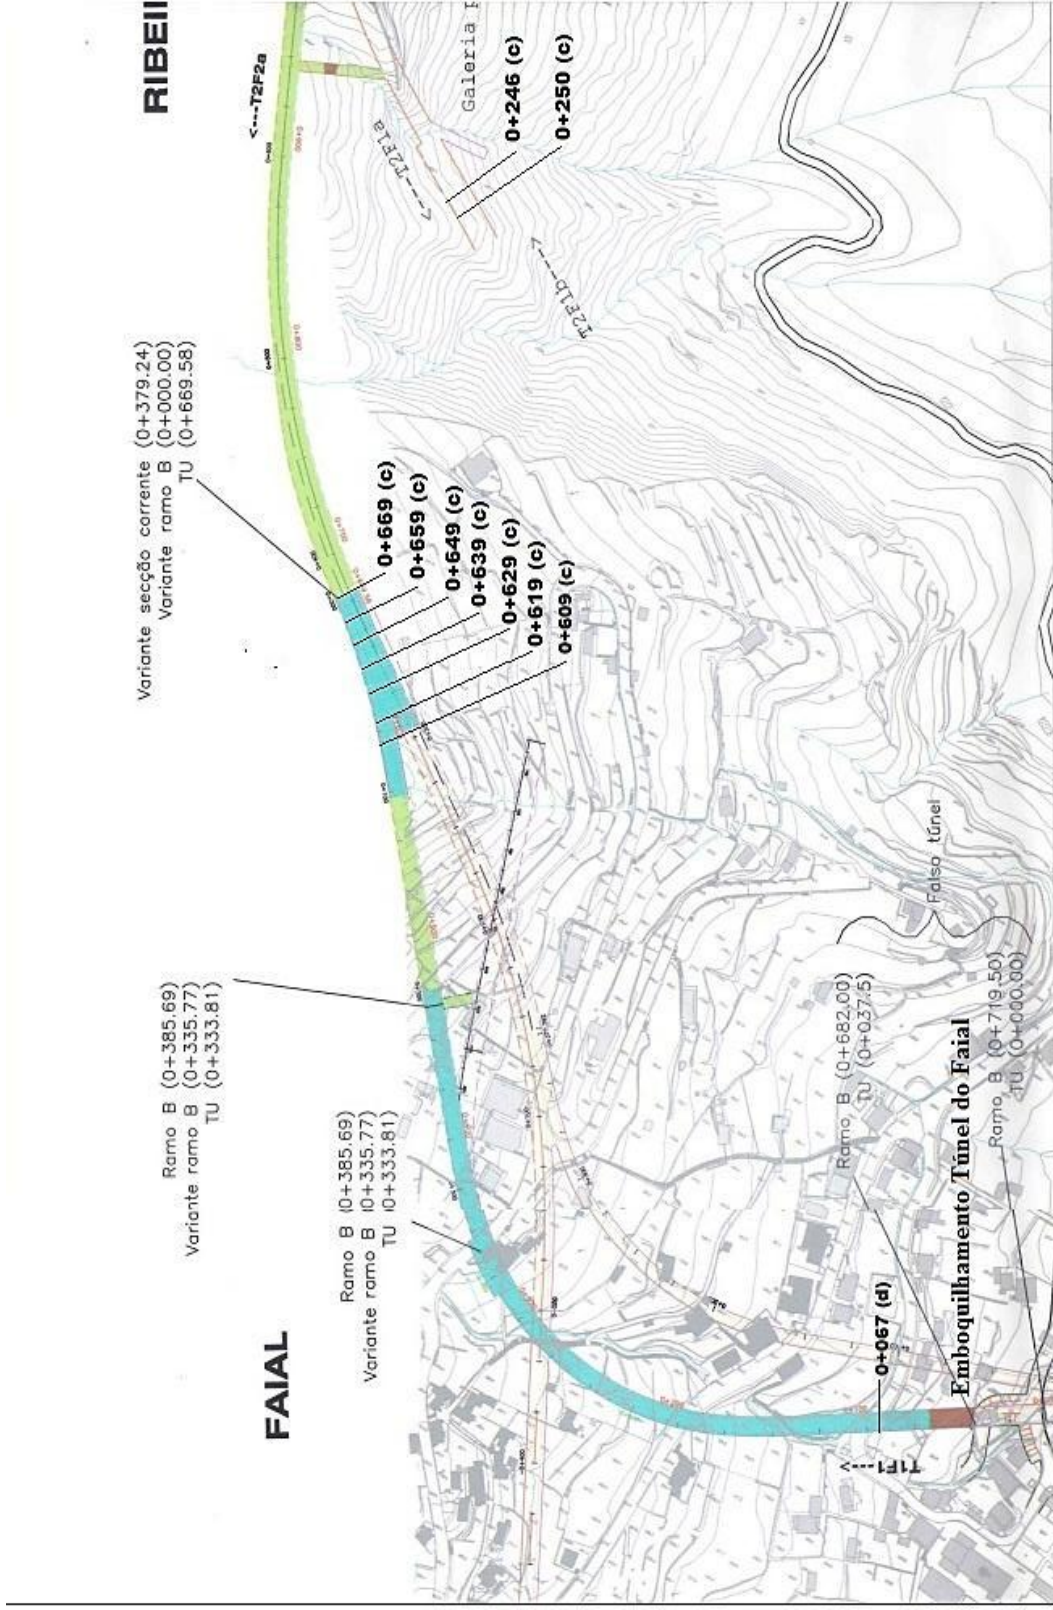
Planta do Túnel do Cortado com secções instrumentadas (Horgan, 2004)
